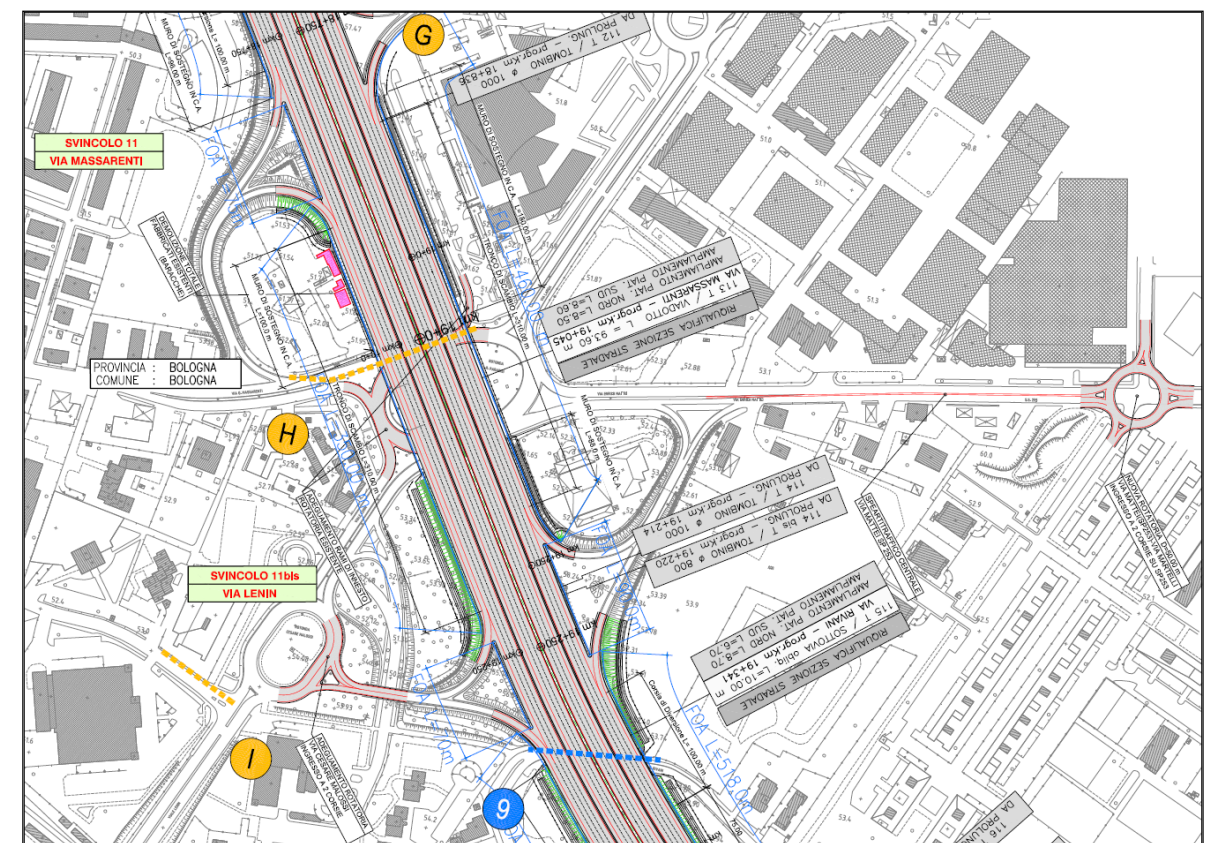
Dettaglio planimetrico Svincolo 11 – Massarenti
